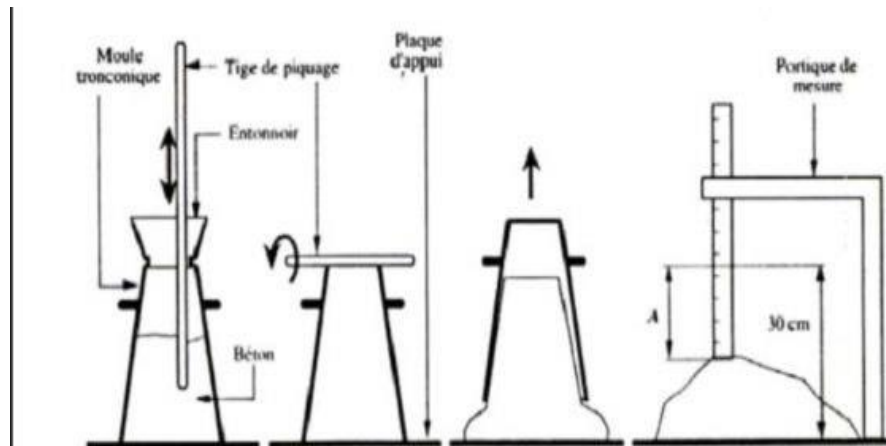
Essai d'affaissement eau cône d'Abram. [35]
